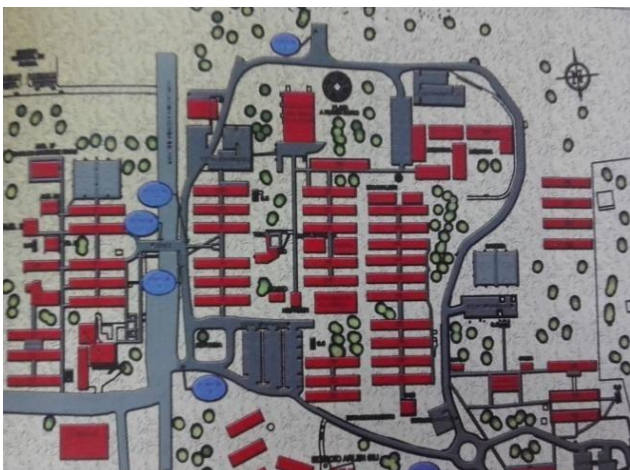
25 Plan Maestro de la UNAN Managua para 1967
